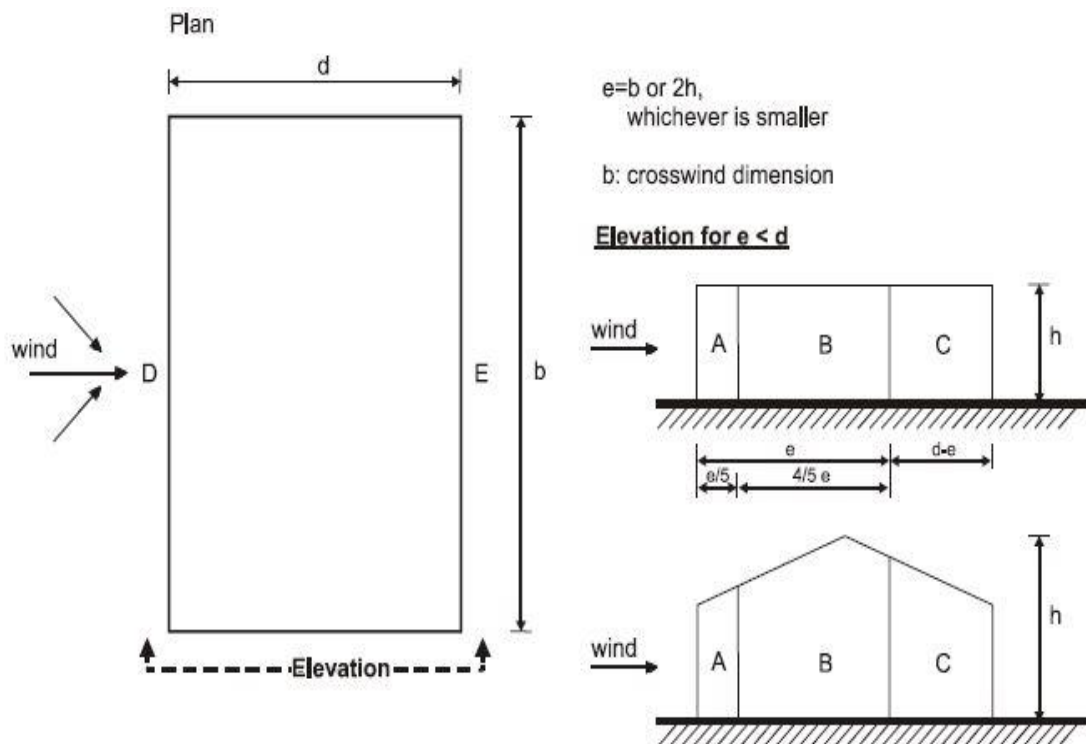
Divisão por zonas nas fachadas devido o vento transversal
